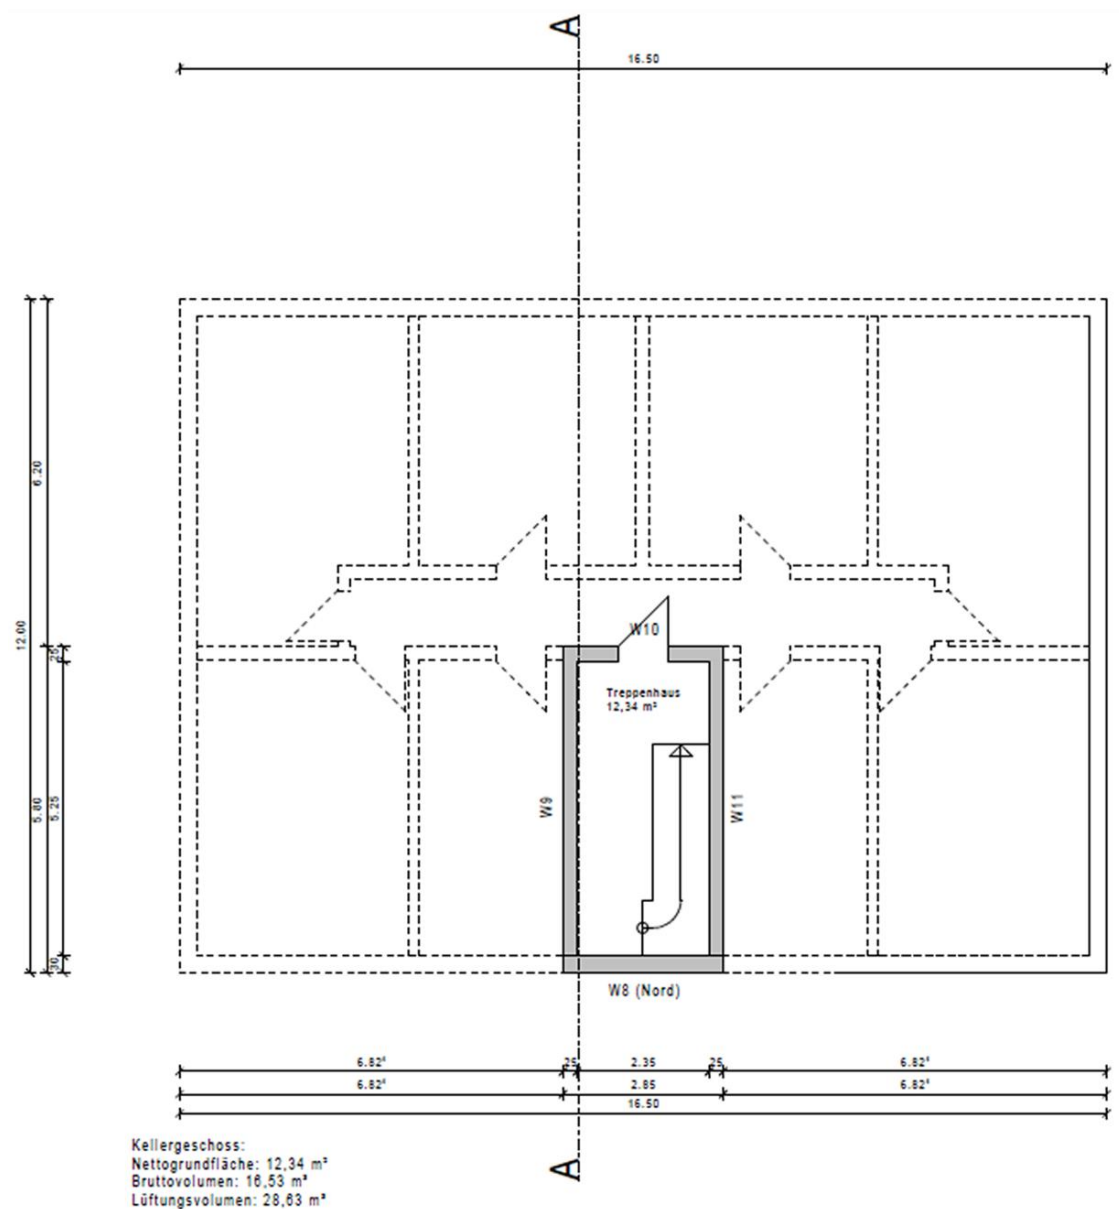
MFH - Grundriss Kellergeschoss
